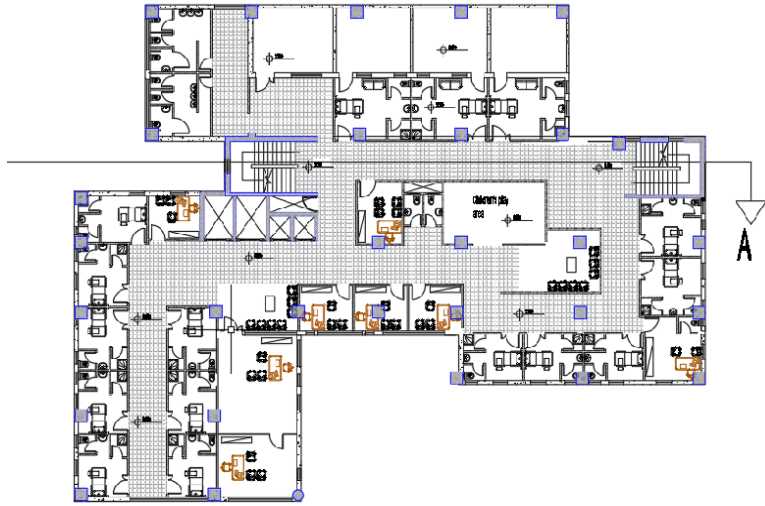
المسقط الأفقي لطابق التسوية.
